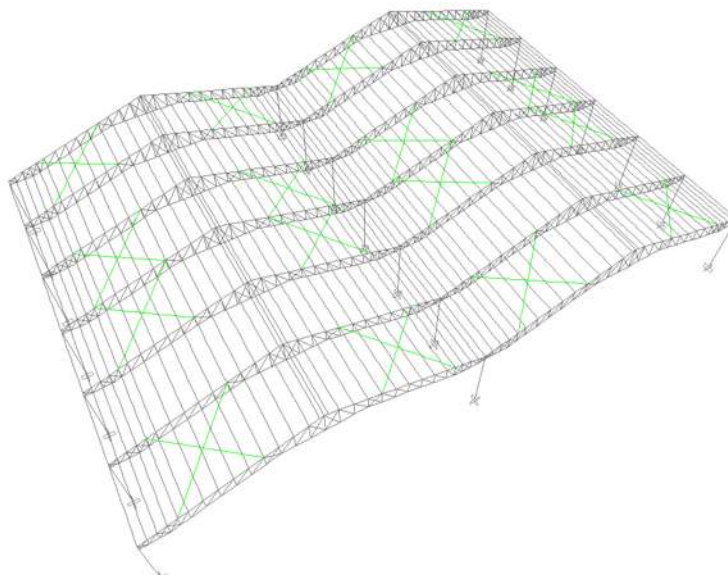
(f) Disposición de los elementos tipo cables (riostras)
